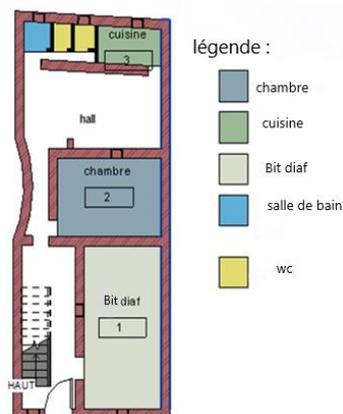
Plan du rez-de-chaussée de dar el djemaa .source : les auteurs 2018.
